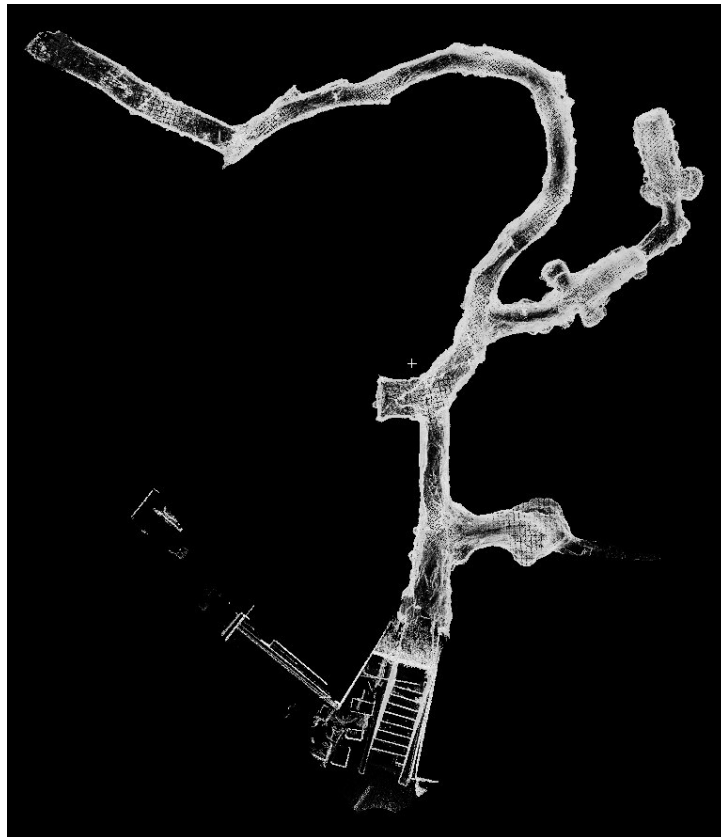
Grundriss (genordet) des Erdstalls, generiert aus der Punktwolke (Abb. 2) mit senkrechter Blickrichtung von oben.
